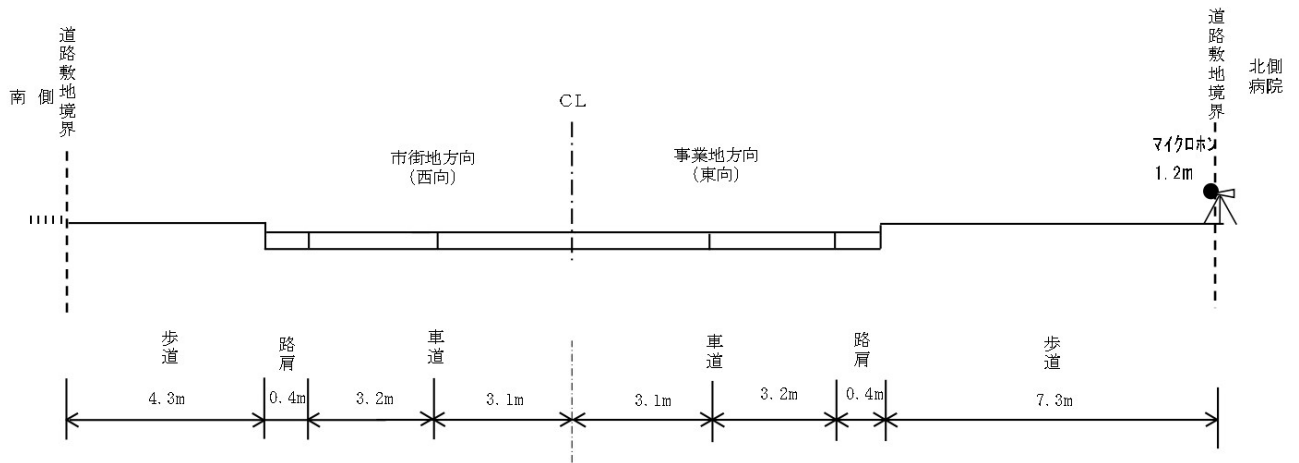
(2) 道路断面図 (K-2 地点 市道米里線)
